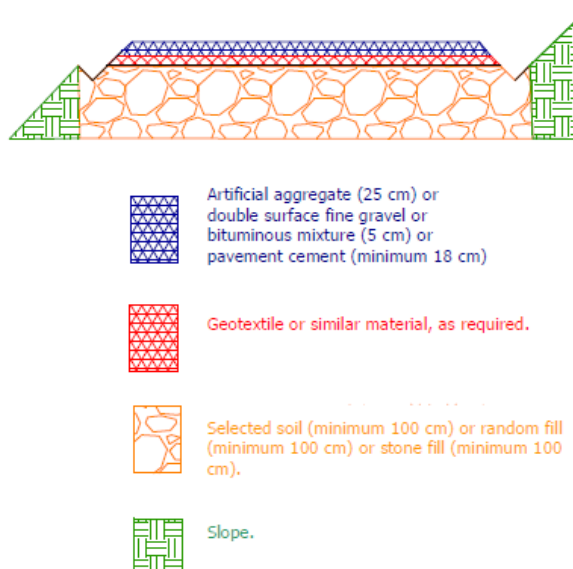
SEZIONE TIPO STRADALE N.2
